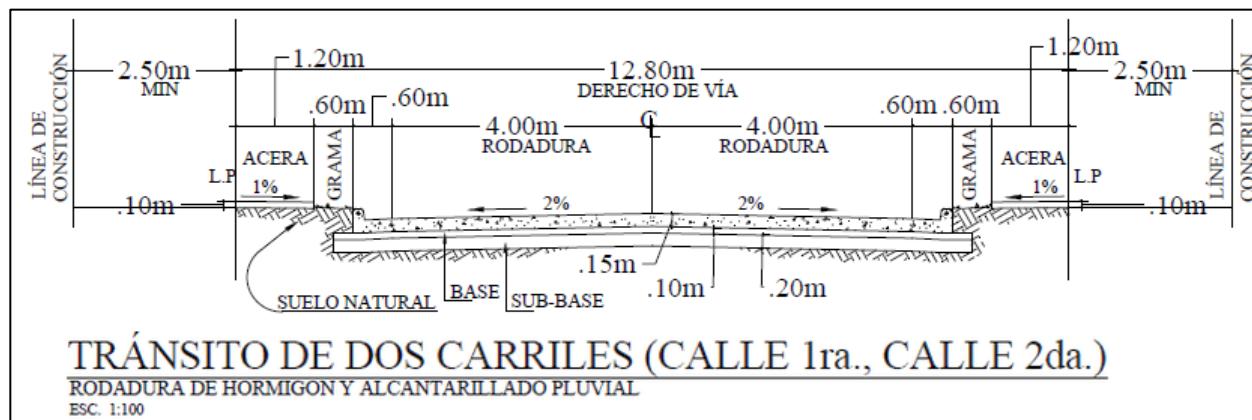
Detalle (Sección) de las calles primera y segunda. Fuente: Planos del proyecto.
